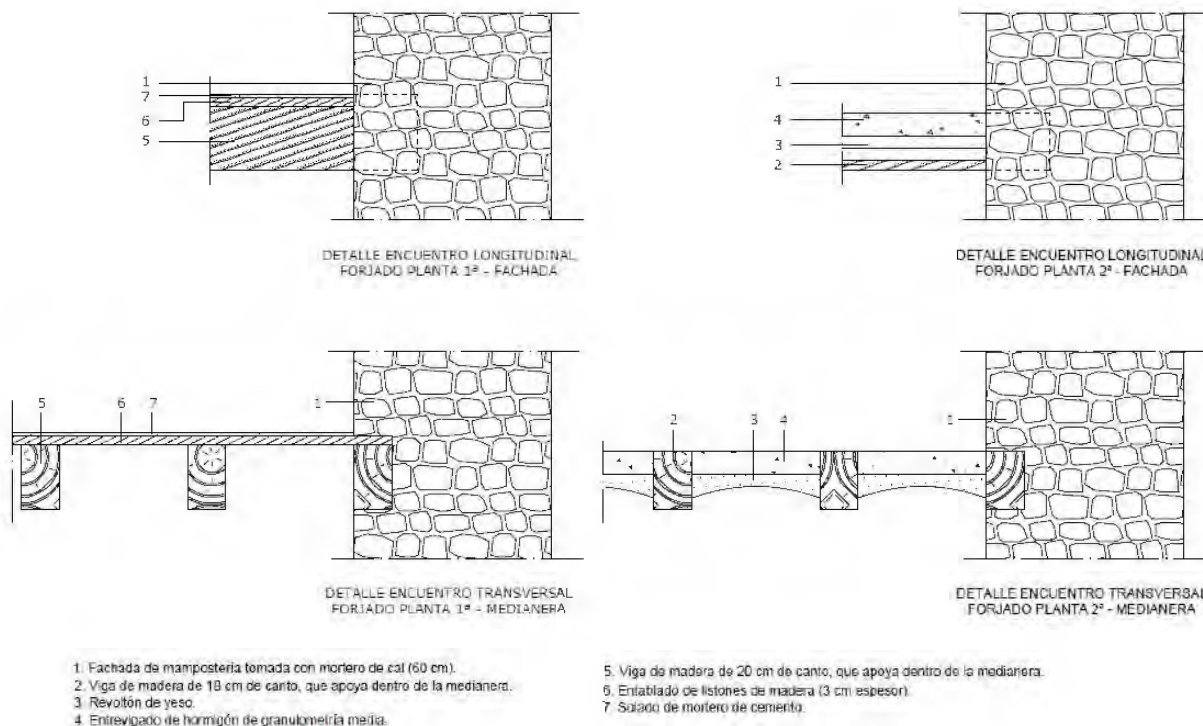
Detalles constructivos forjados planta primera y segunda. Fuente: propia.
